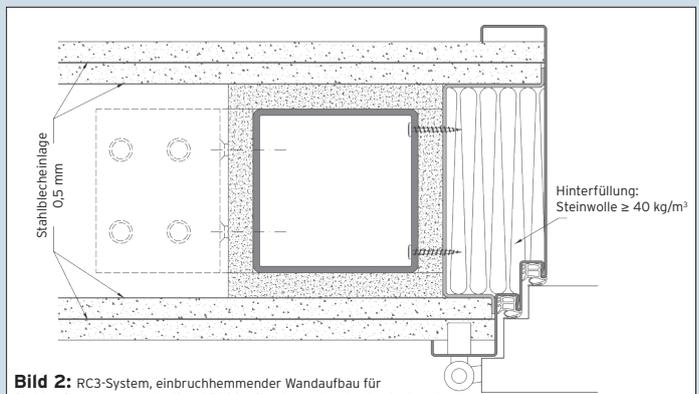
RC3-System, einbruchhemmender Wandaufbau für Stahlumfassungszarge (optional EI_{1,30} mit entsprechender Beplankung)
